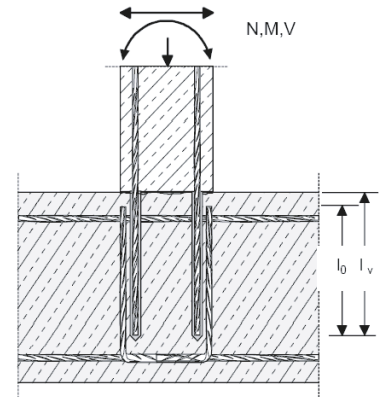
giunzione per sovrapposizione di pilastri sollecitati a flessione o muri a fondazioni.
